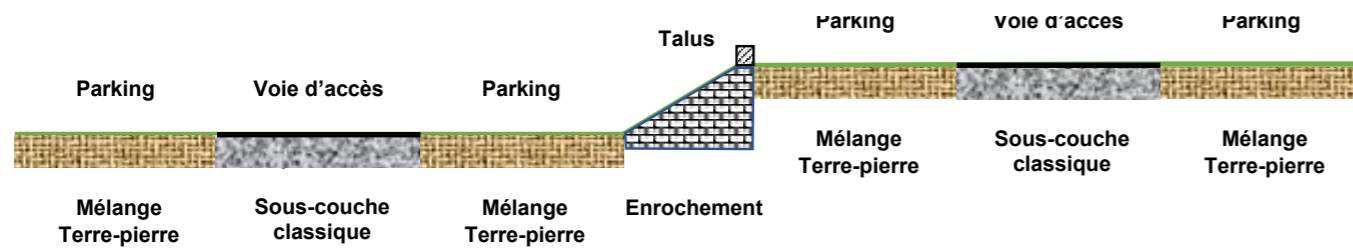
Parking Sud Salle des fêtes en terrasse : vue en coupe
